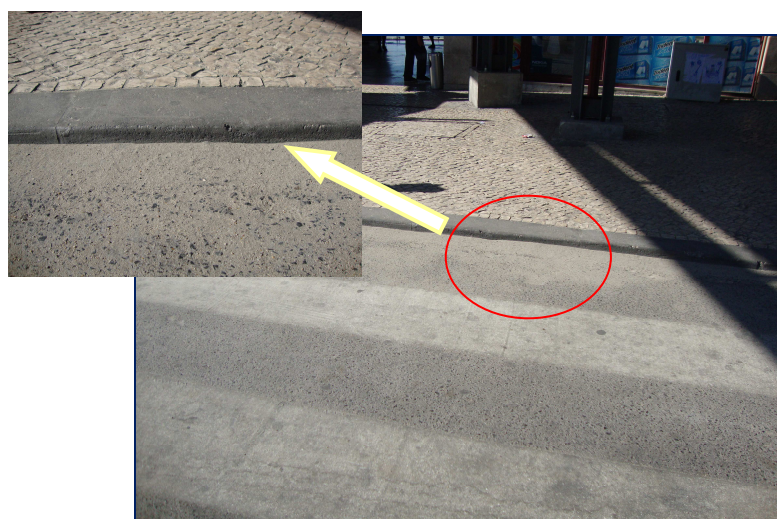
Ressalto entre o pavimento da via e o passeio
